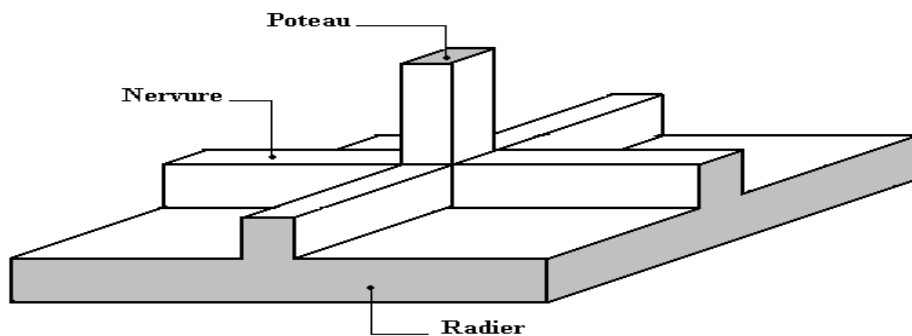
disposition des nervures par rapport au radier et poteau
